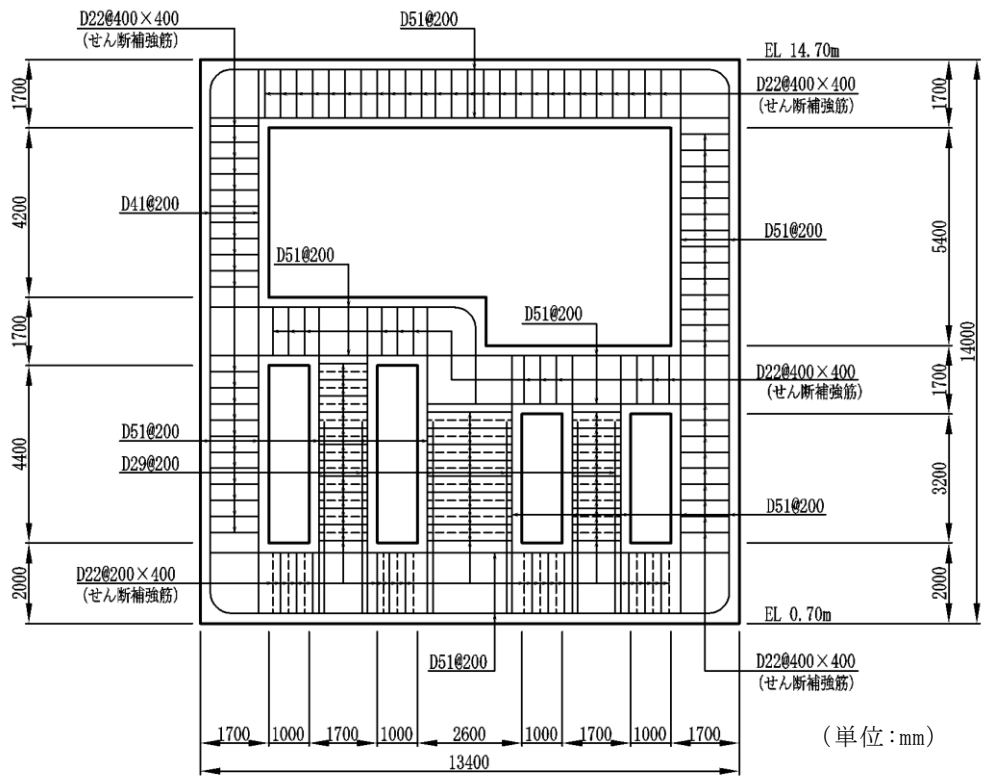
第 1 ベントフィルタ格納槽概略配筋図 (B-B 断面)
